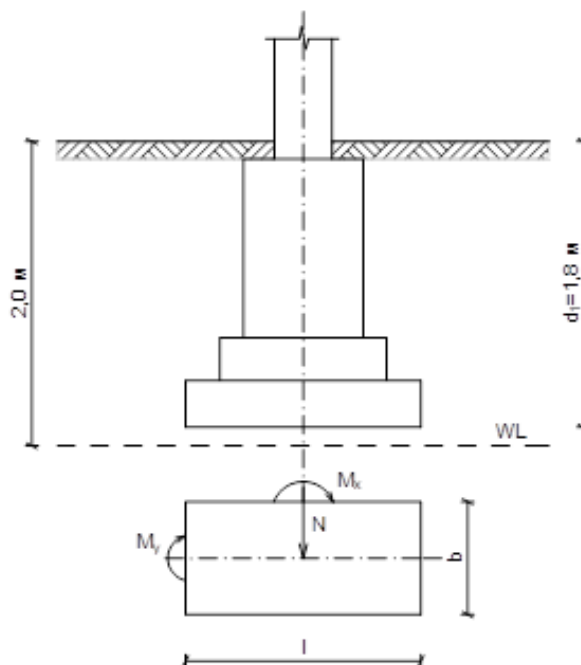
Схема розташування фундаменту у ґрунті і навантажень на фундамент
